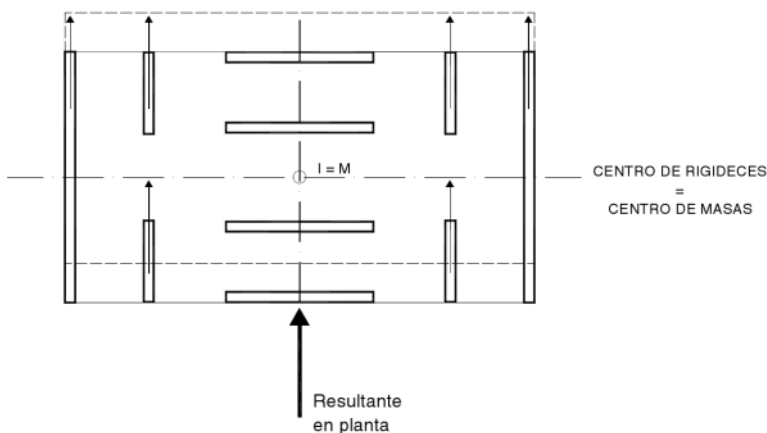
RESULTANTE EN PLANTA DE LA FUERZA HORIZONTAL
